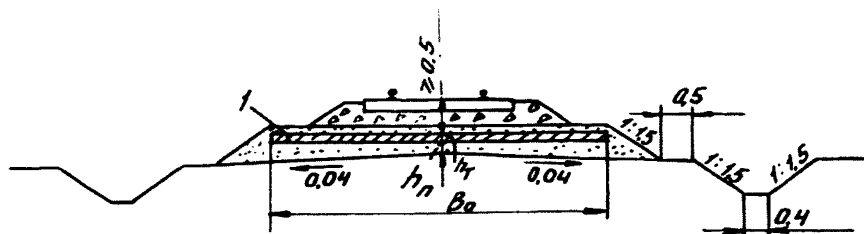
Схема размещения тепловой изоляции в поперечном сечении земляного полотна:
